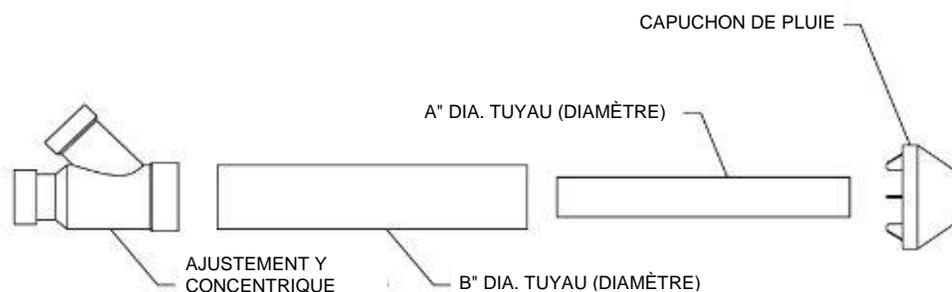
Identification des pièces des ensembles d'évent concentriques 3" et 4"
